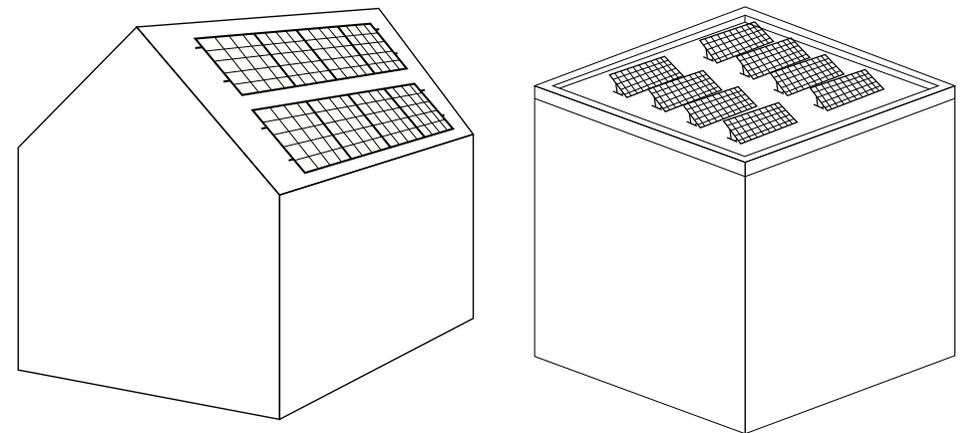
| Positionierung von Technikflächen auf verschiedenen Dachformen
